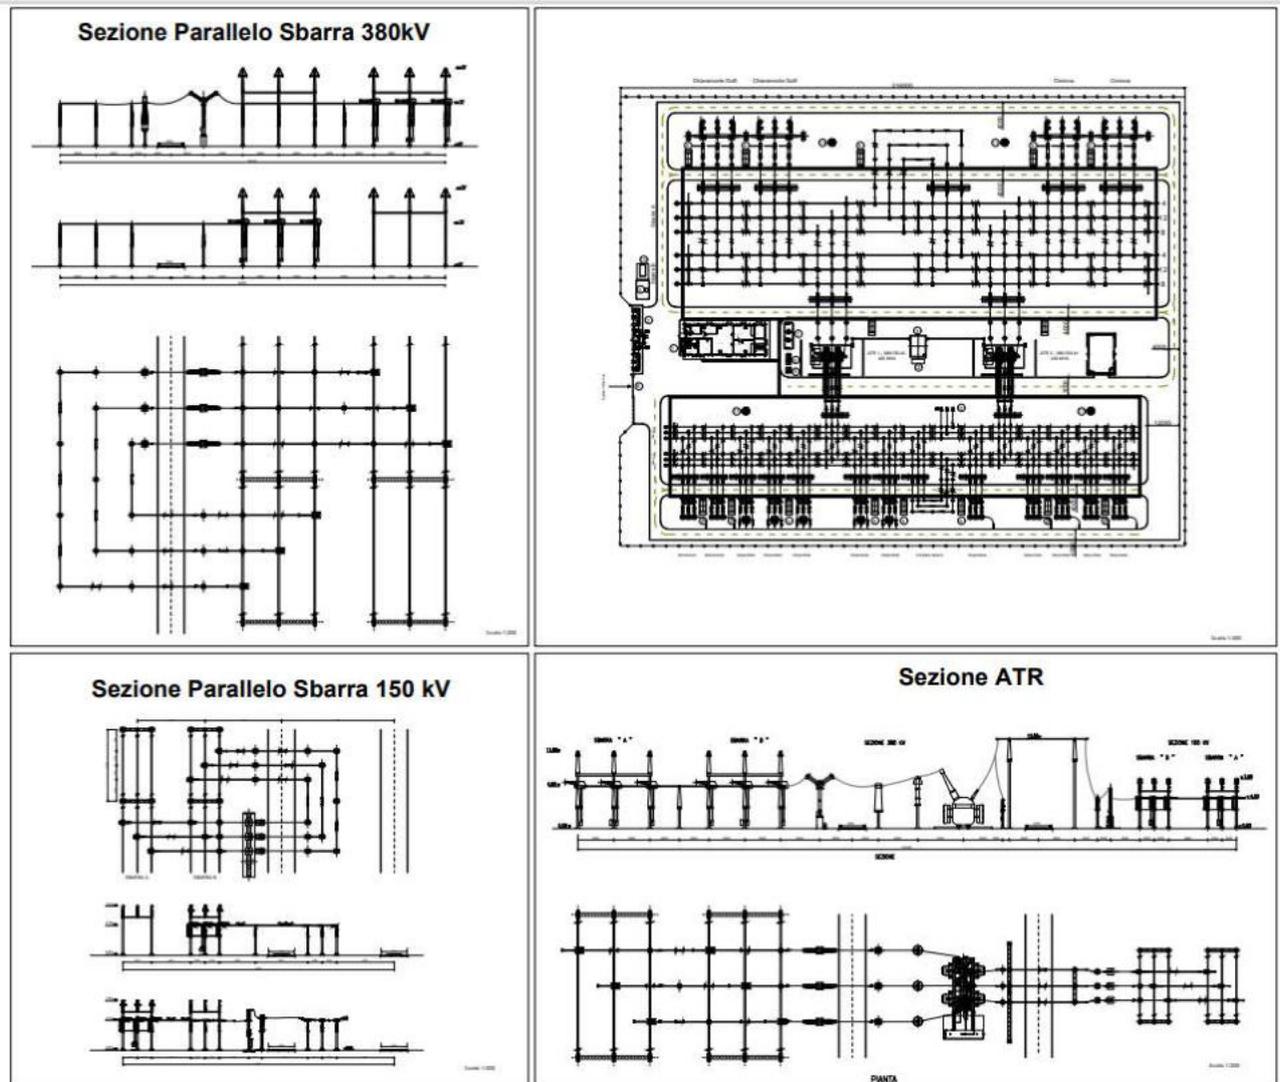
Pianta e sezione elettromeccanica SSE 380_150 kv
